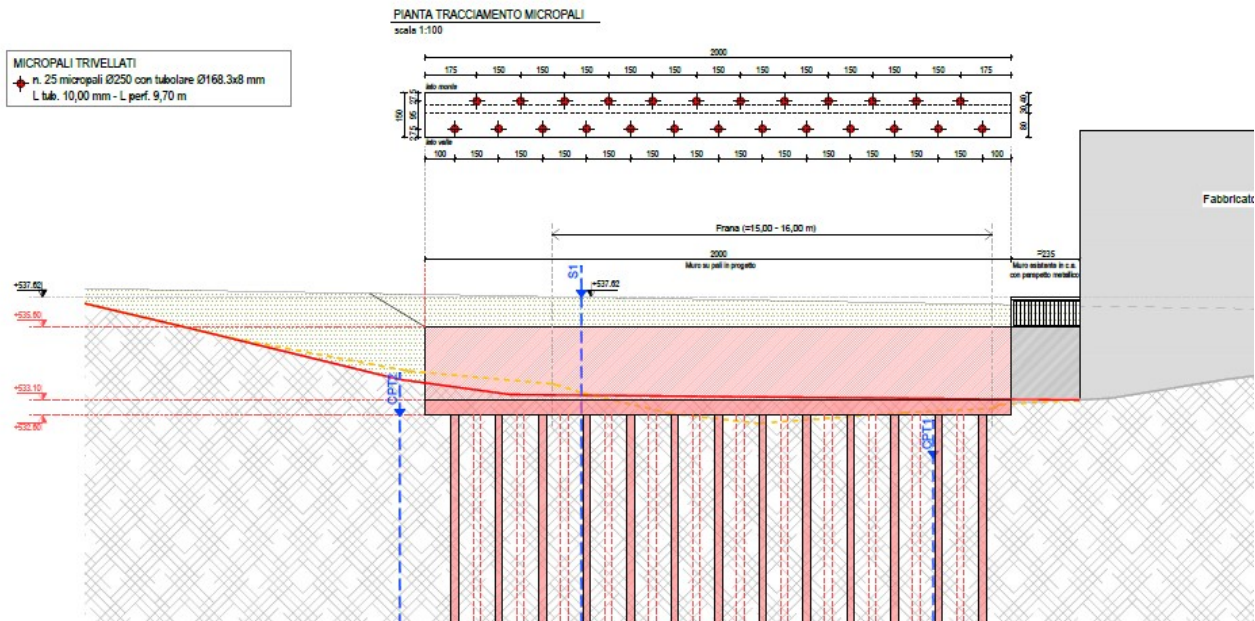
Estratto della planimetria di progetto (v. elaborato C2).
